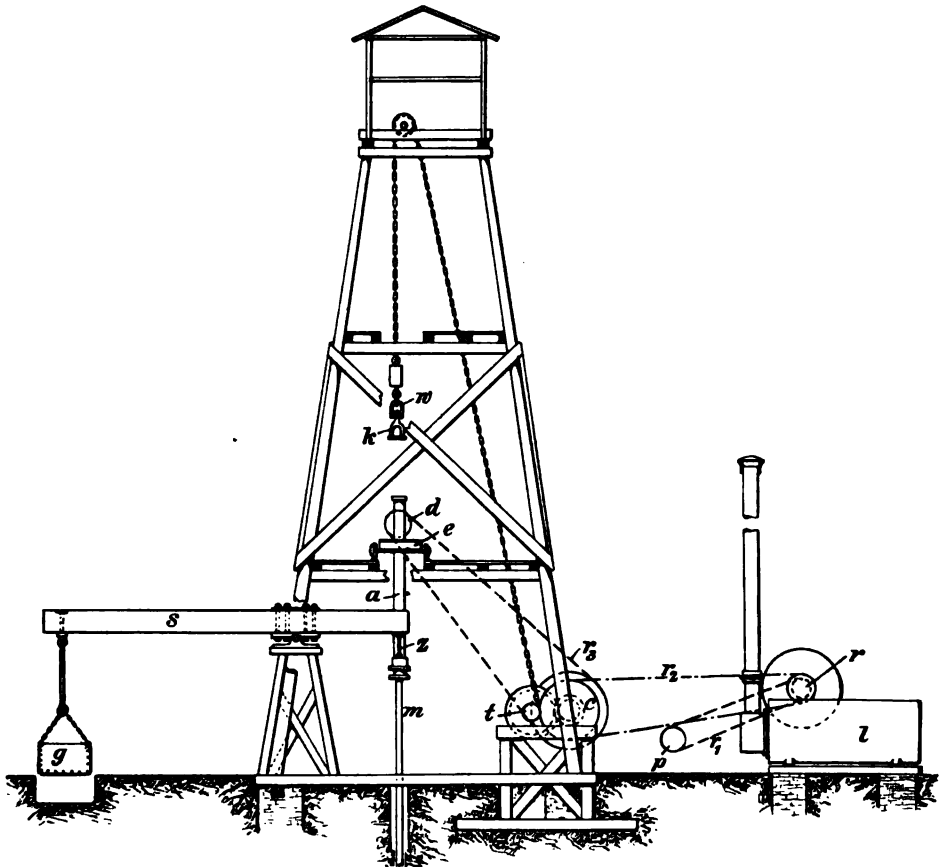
Schema einer Bohranlage für Diamant- und Meißelbohrung.
